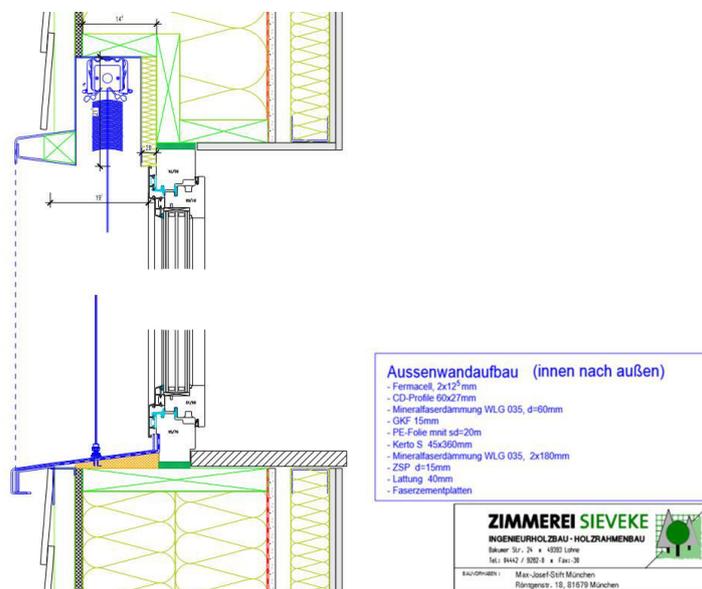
Fassadenaufbau mit Fensterdetail (Projekt A)⁴¹⁵
